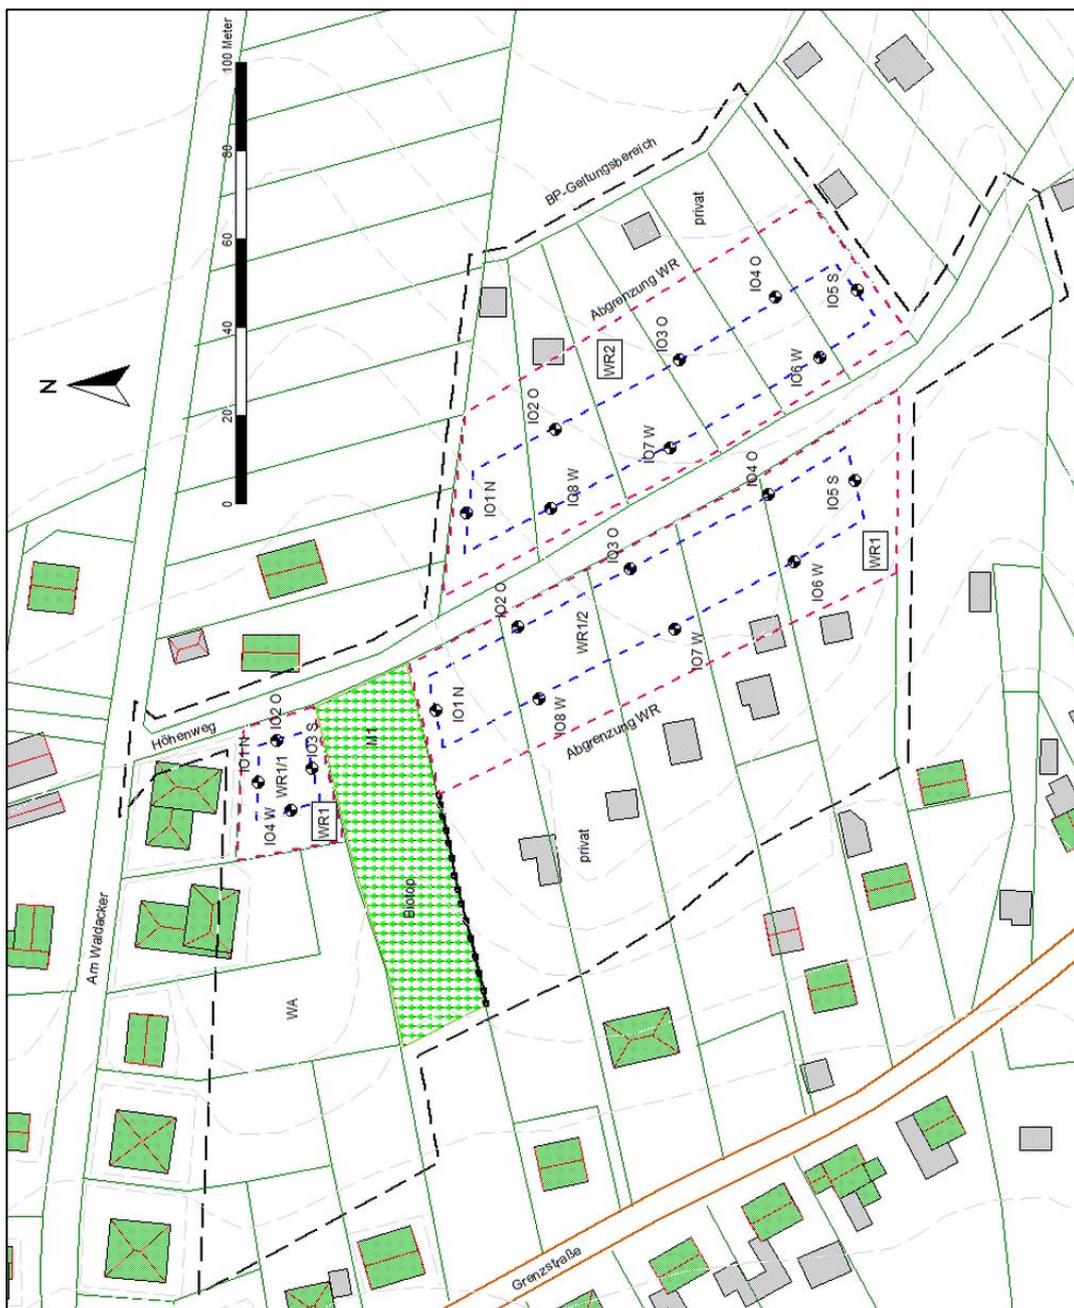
Lageplan mit Baugrenzen und Anordnung der Immissionsorte auf den Baugrenzen
